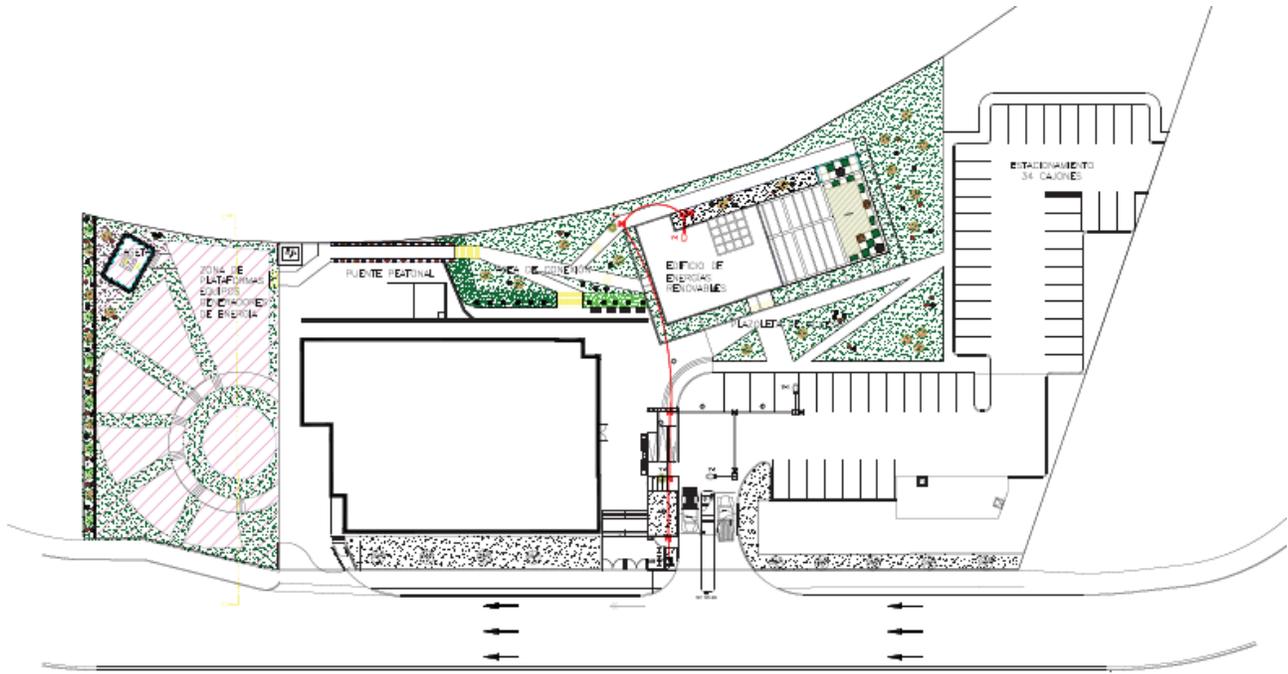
Red de suministro eléctrico para la iluminación exterior de la nave, en esta fase 2.
